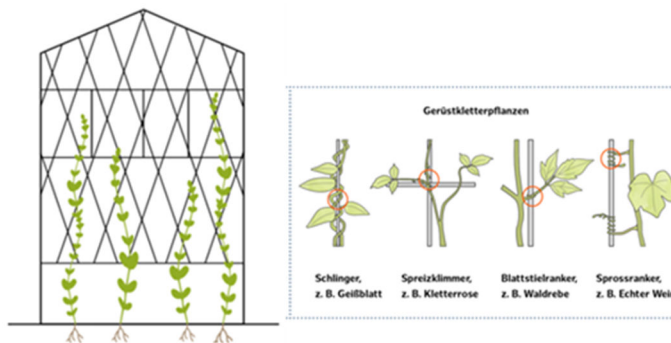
Darstellung von Fassadenbegrünung mit Rankhilfen (Quelle: Handbuch Grüne Wände, Stadt Hamburg)
